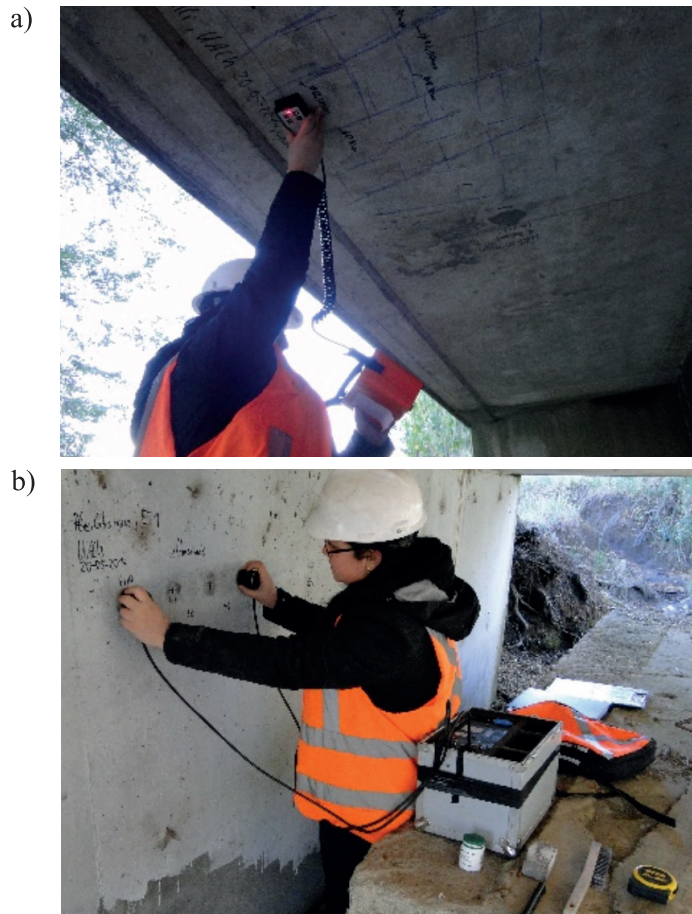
a) Realización del ensayo con Pacómetro en el Puente Trafampulli, Cunco y b) realización del ensayo con ultrasonido en el estribo de hormigón del Puente Caburgua.
